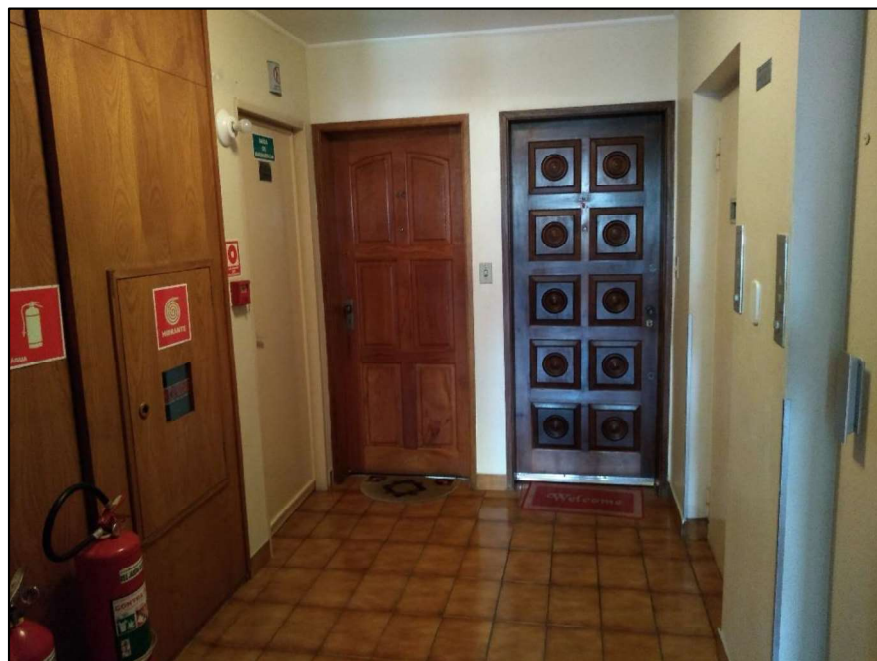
Aspectos de hall comum do 1º pavimento do Ed. Grapiá.
